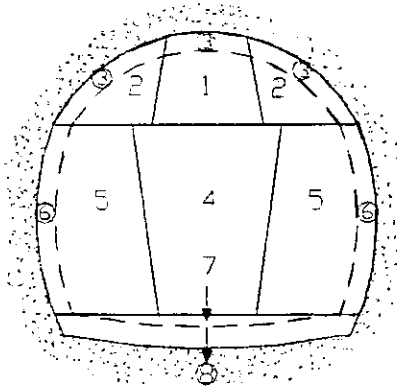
PROCEDIMIENTO DE EXCAVACION
